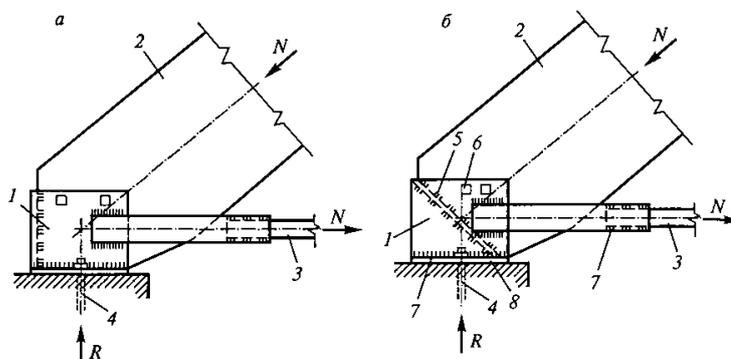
Опорные узлы арок с затяжками: а — с вертикальной диафрагмой; б — то же, с наклонной; 1 — башмак; 2 — арка; 3 — затяжка; 4 — анкер; 5 — диафрагма; 6 — болт; 7 — сварной шов; 8 — опорный лист
